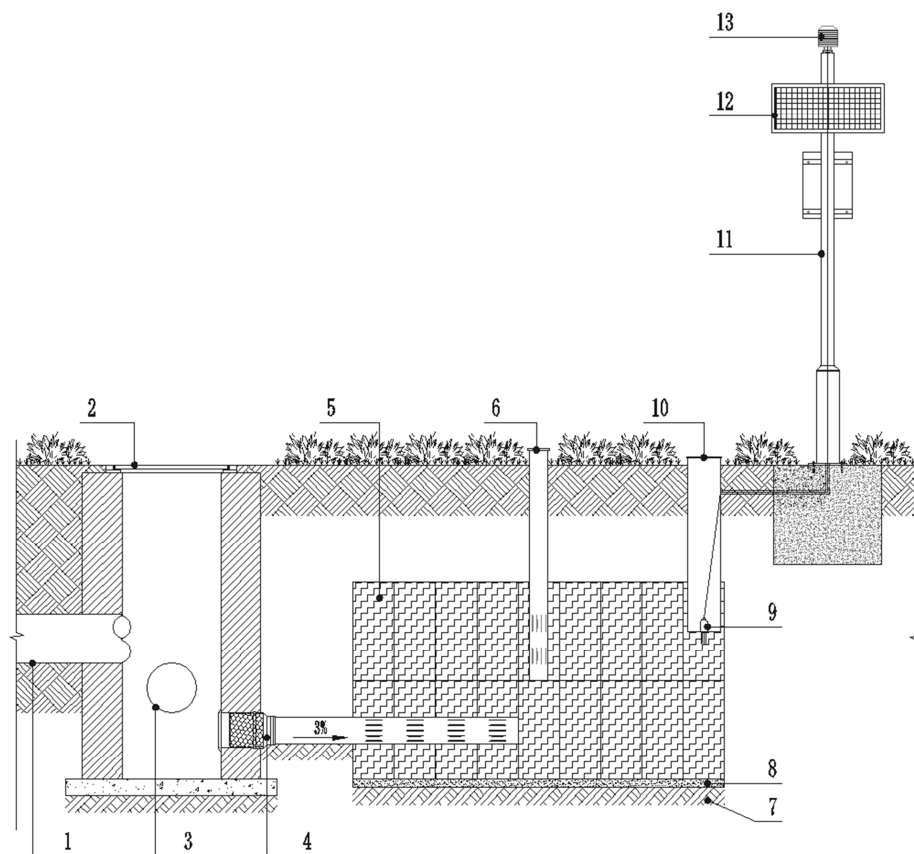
系统与建筑内排水做法应用构造示意图
